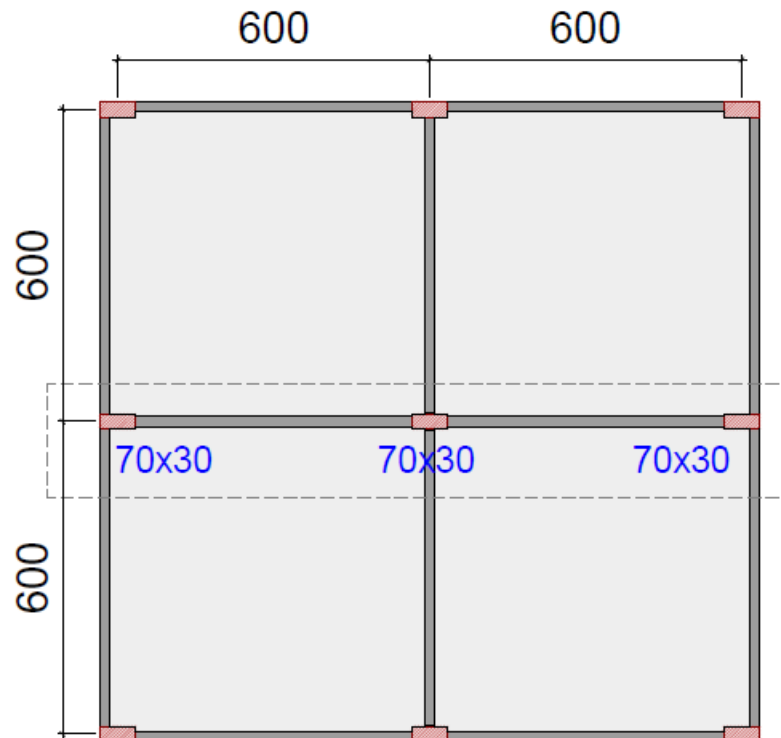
Pórtico plano de 12 pavimentos e 2 vãos: seleção na planta do pavimento tipo.
